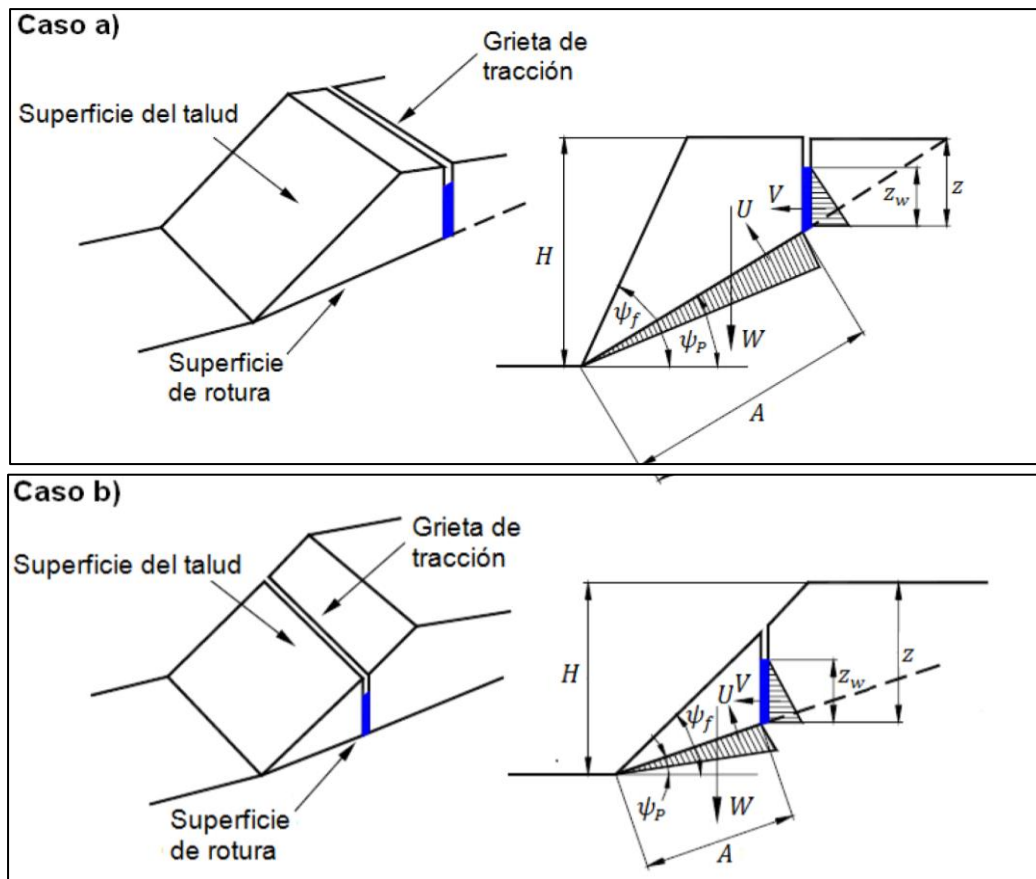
Rotura planar: a) Grieta de tracción ubicada en la cabecera del talud y b) Grieta de tracción ubicada en la cara del talud.
